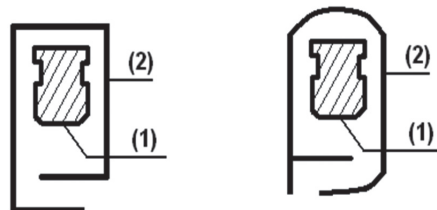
Zasilanie tramwaju w Bordeaux poprzez szynę segmentową [10]
